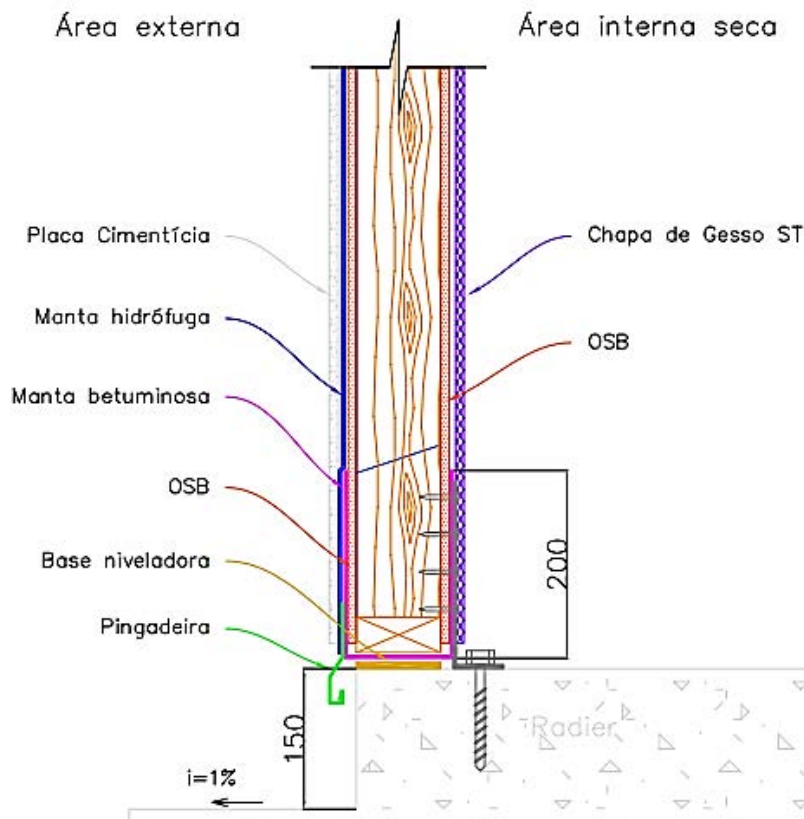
Detalhe da fixação da parede externa no elemento de fundação.
